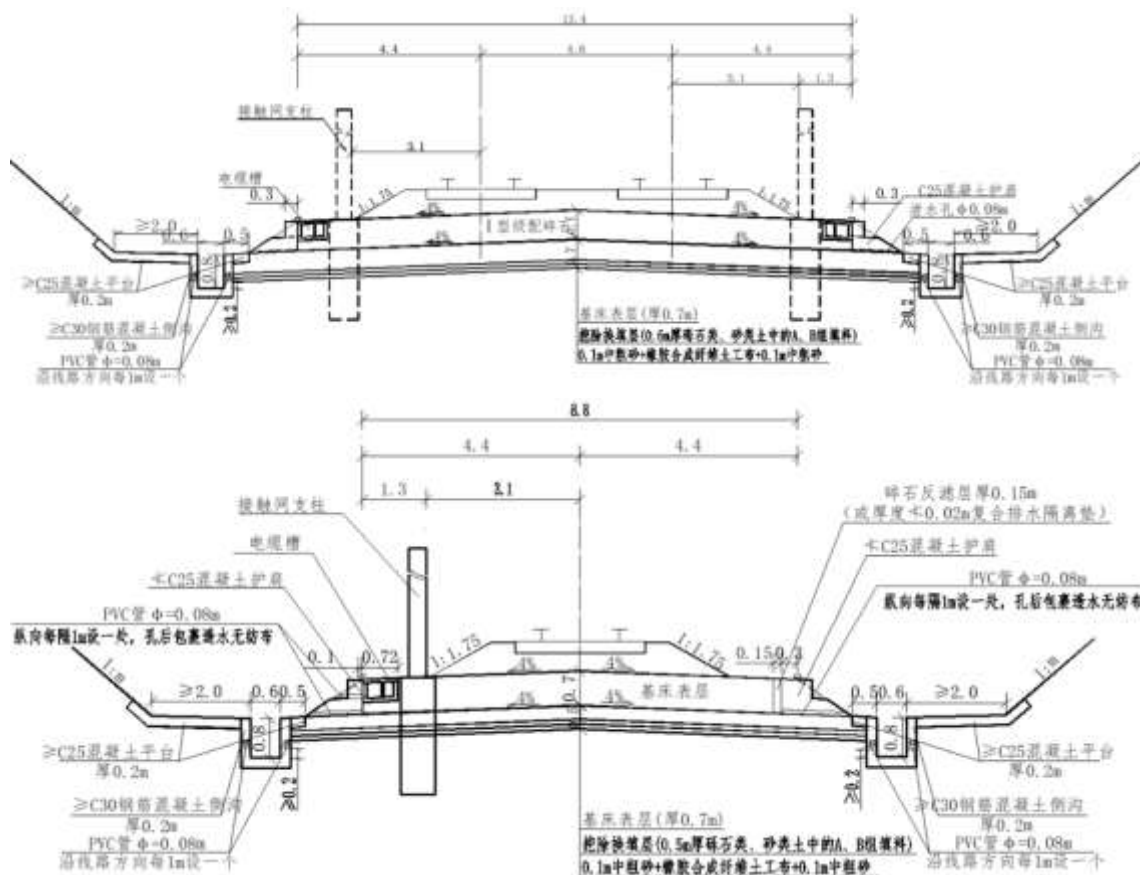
250km/h 双线及单线有砟轨道路基标准横断面图 (单位: m)
